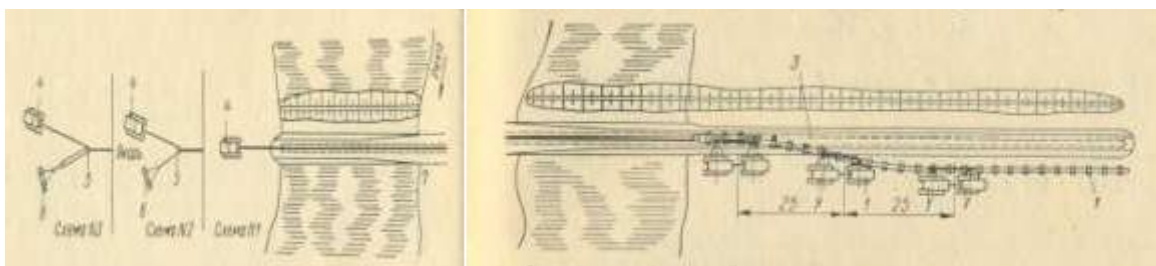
Схема протаскивания трубопровода с береговой траншеей
